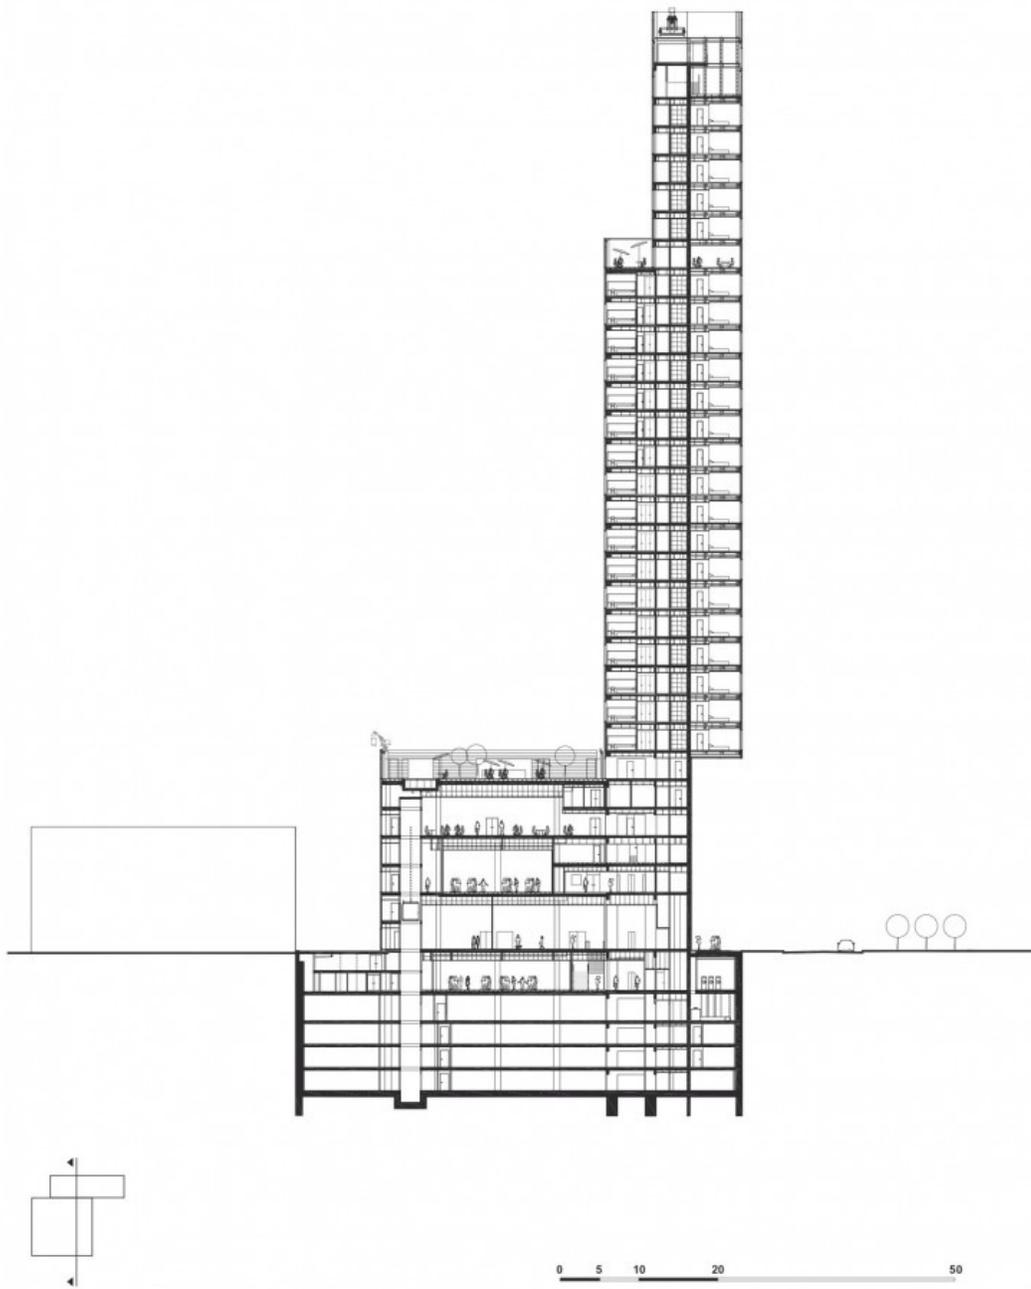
HOTEL ME BARCELONA – CORTE TRANSVERSAL
